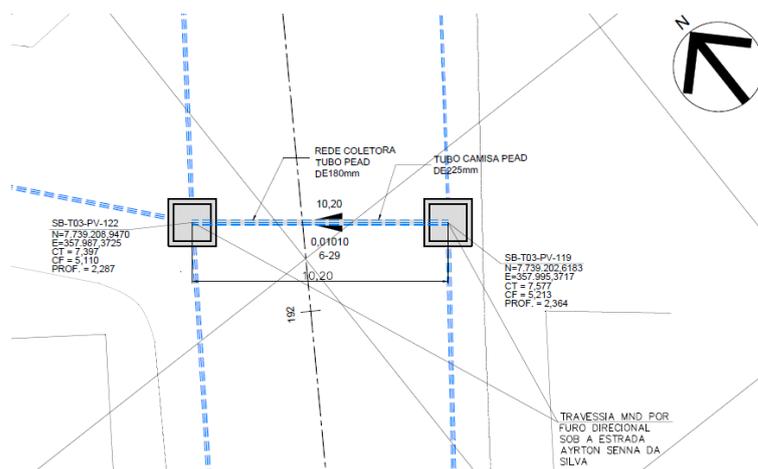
Planta de localização da travessia SB-T03 - PV-119 ao PV-122
